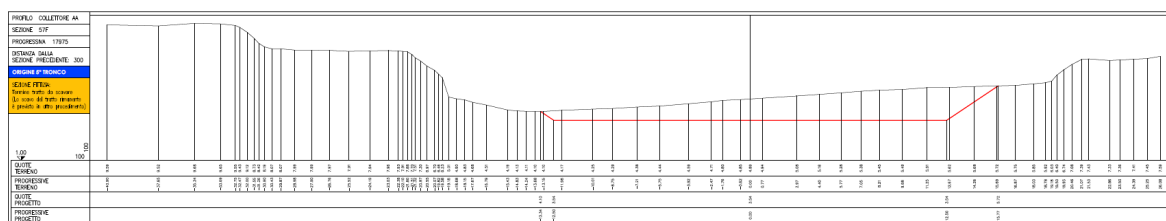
Sezione trasversale di scavo a valle, al termine del tratto oggetto di intervento (sez 57F).
